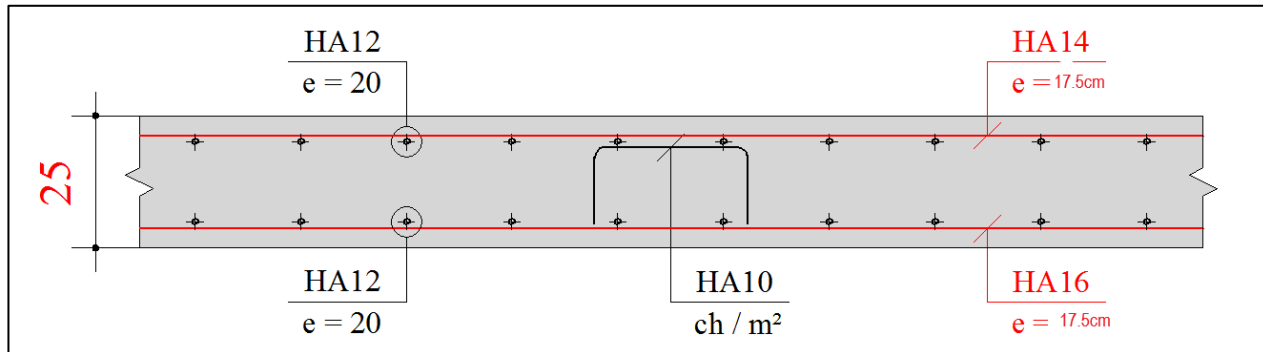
Ferrailage de la dalle (coupe transversale)
